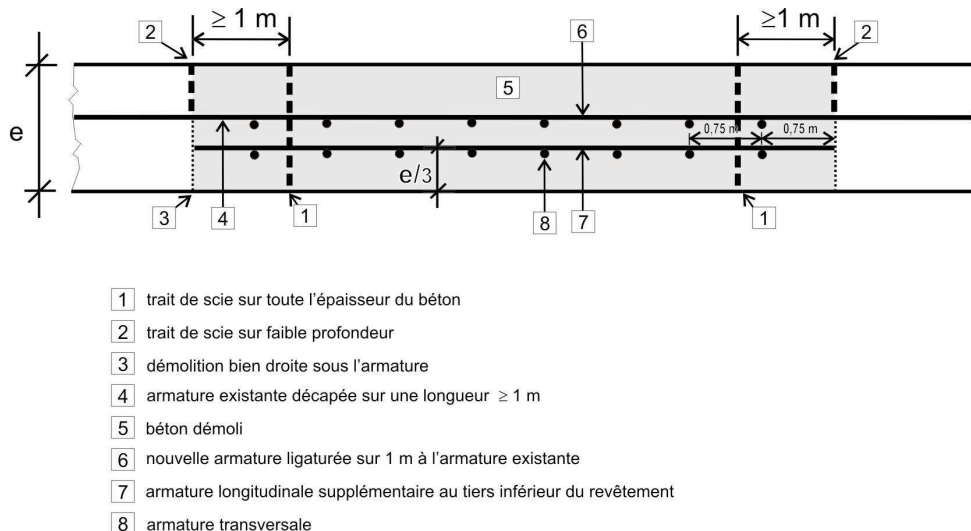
Rétablissement du ferrailage dans une réparation en béton armé continu.
